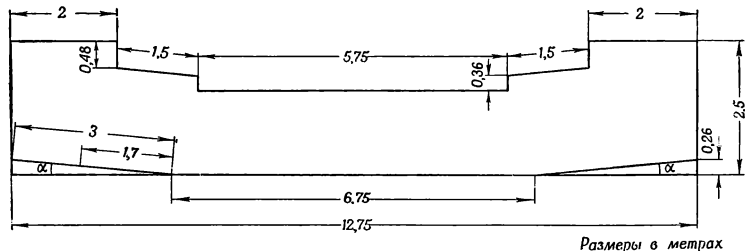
Основные габаритные размеры стрельбища по «бегущему оленю» (для мелкокалиберной винтовки)
